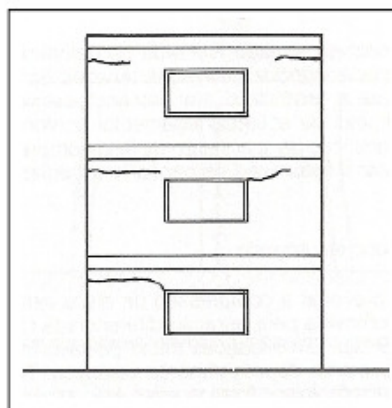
Fissuras em paredes externas causadas pela retração de lajes intermediárias
